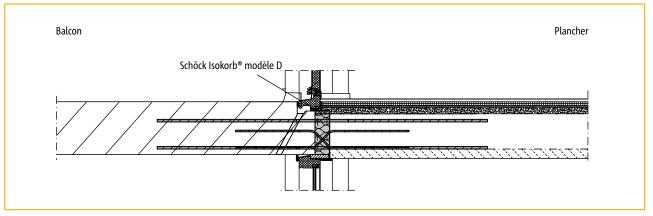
Liaison rupteur Schöck Isokorb® modèle D : balcon préfabriqué et prédalle
